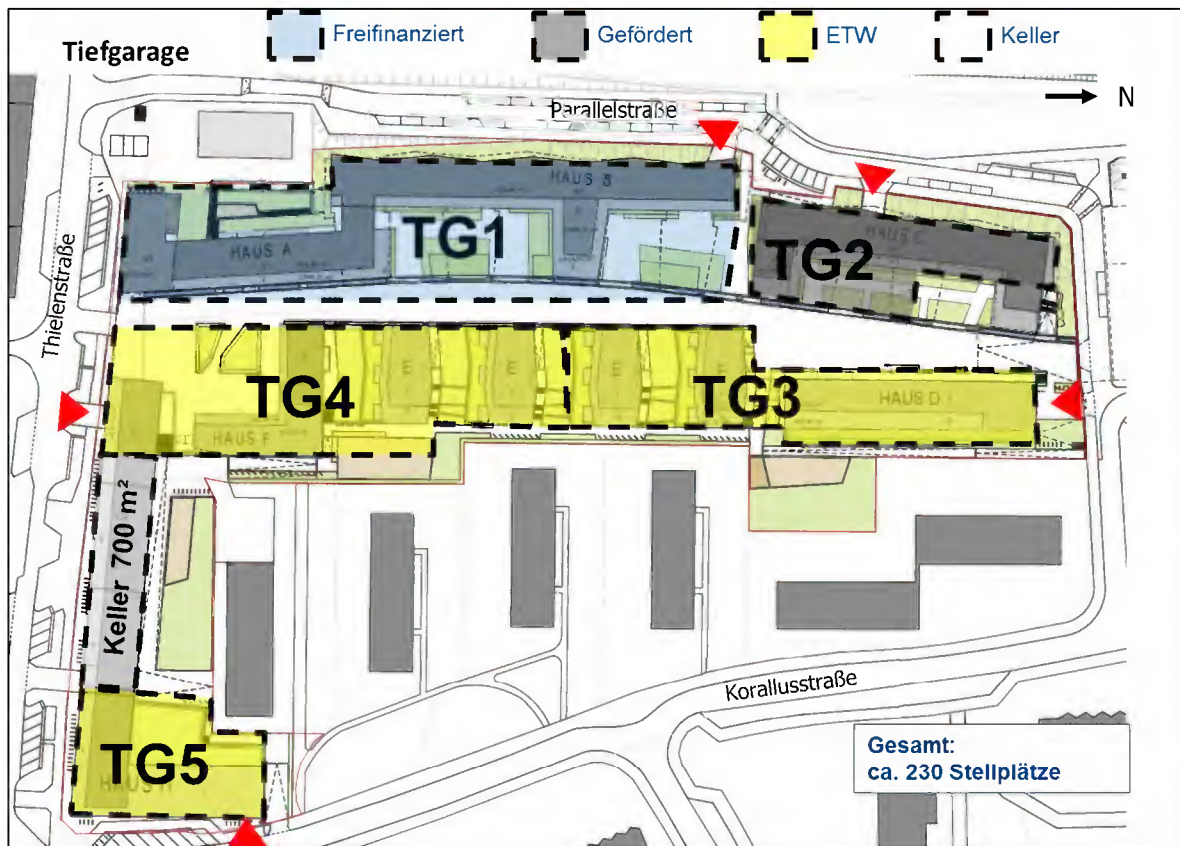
geplante Tiefgaragen mit Zufahrten (Quelle: GERCHGROUP)
